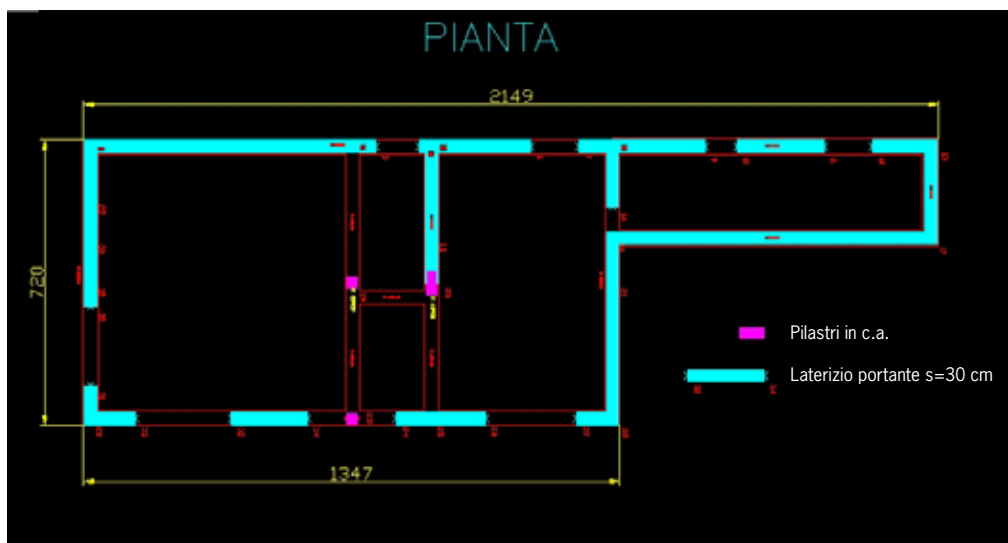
Dettaglio dimensionale del fabbricato (misure in cm).
